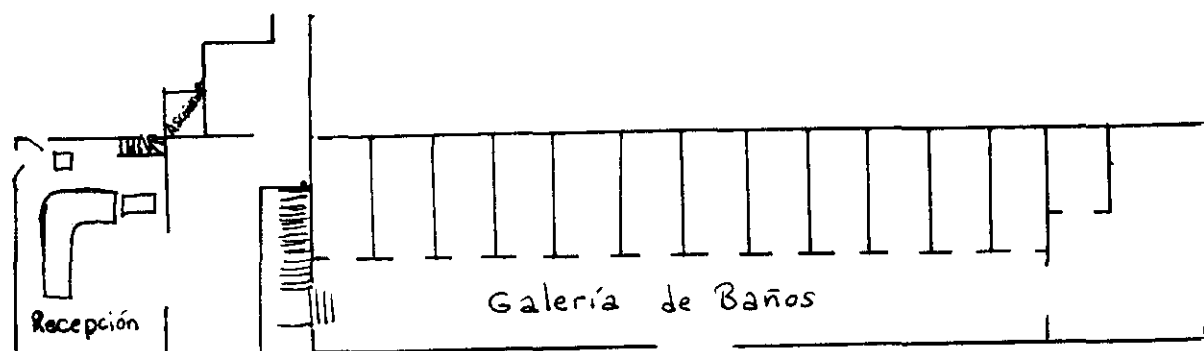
Plano planta baja del Hotel Termas. (B. Termas Pallarés).
